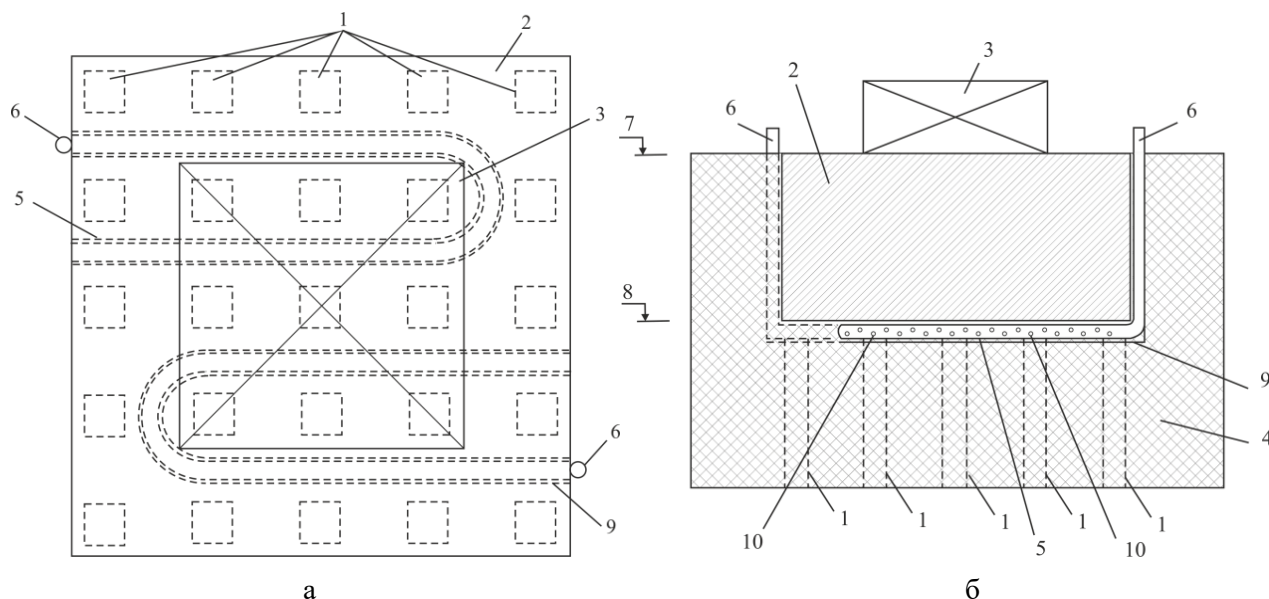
Схема свайного фундамента: а – вид сверху; б – разрез по А-А; 1 – сваи; 2 – ростверк; 3 – машина с динамическими нагрузками; 4 – грунтовое основание; 5 – инъекционные U-образные трубы; 6 – вертикальные выпуски инъекционных труб; 7 – уровень верхнего обреза ростверка; 8 – уровень подошвы ростверка; 9 – горизонтальные U-образные пазы; 10 – перфорационные отверстия труб
